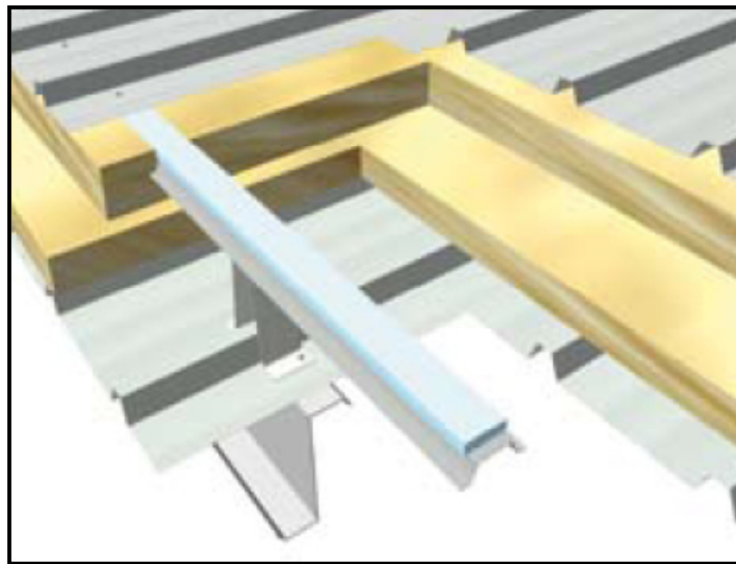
Roof system - TIPO 3: Double Skin Roof
